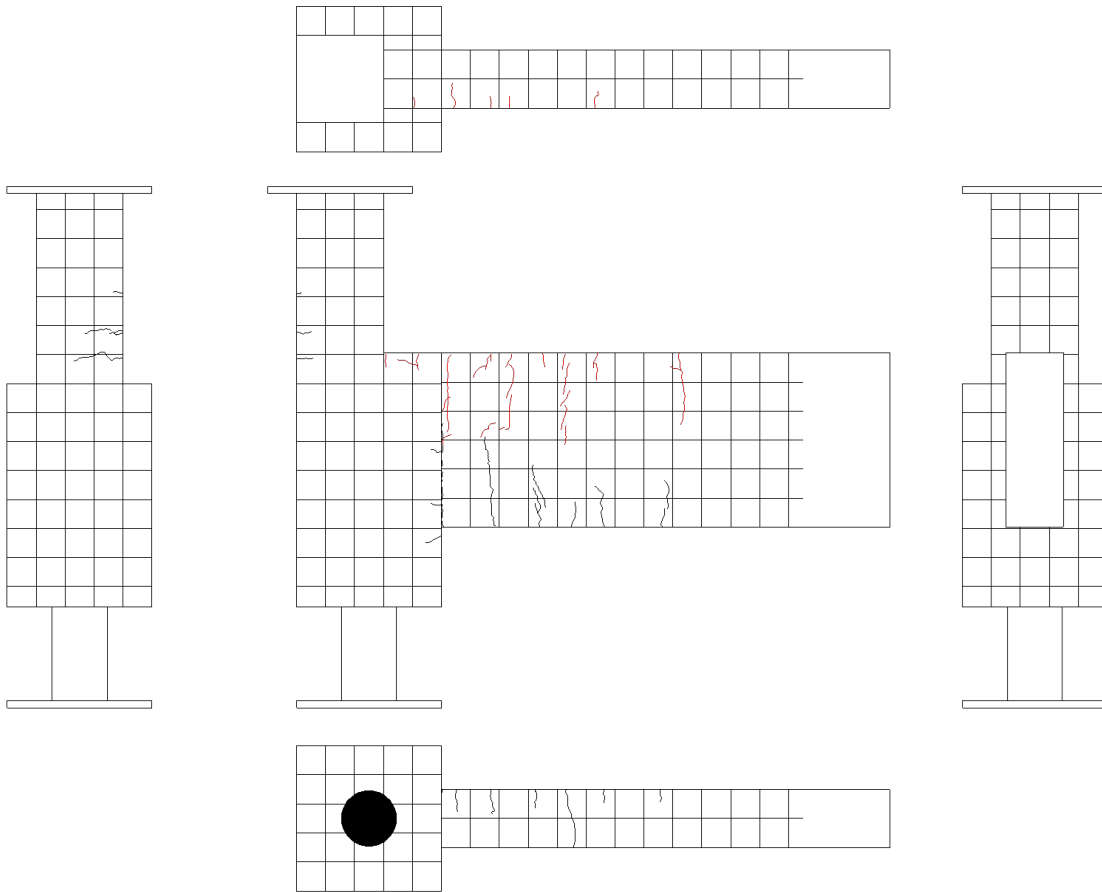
試験体 B-1 ひび割れ状況 (10Cycle)
